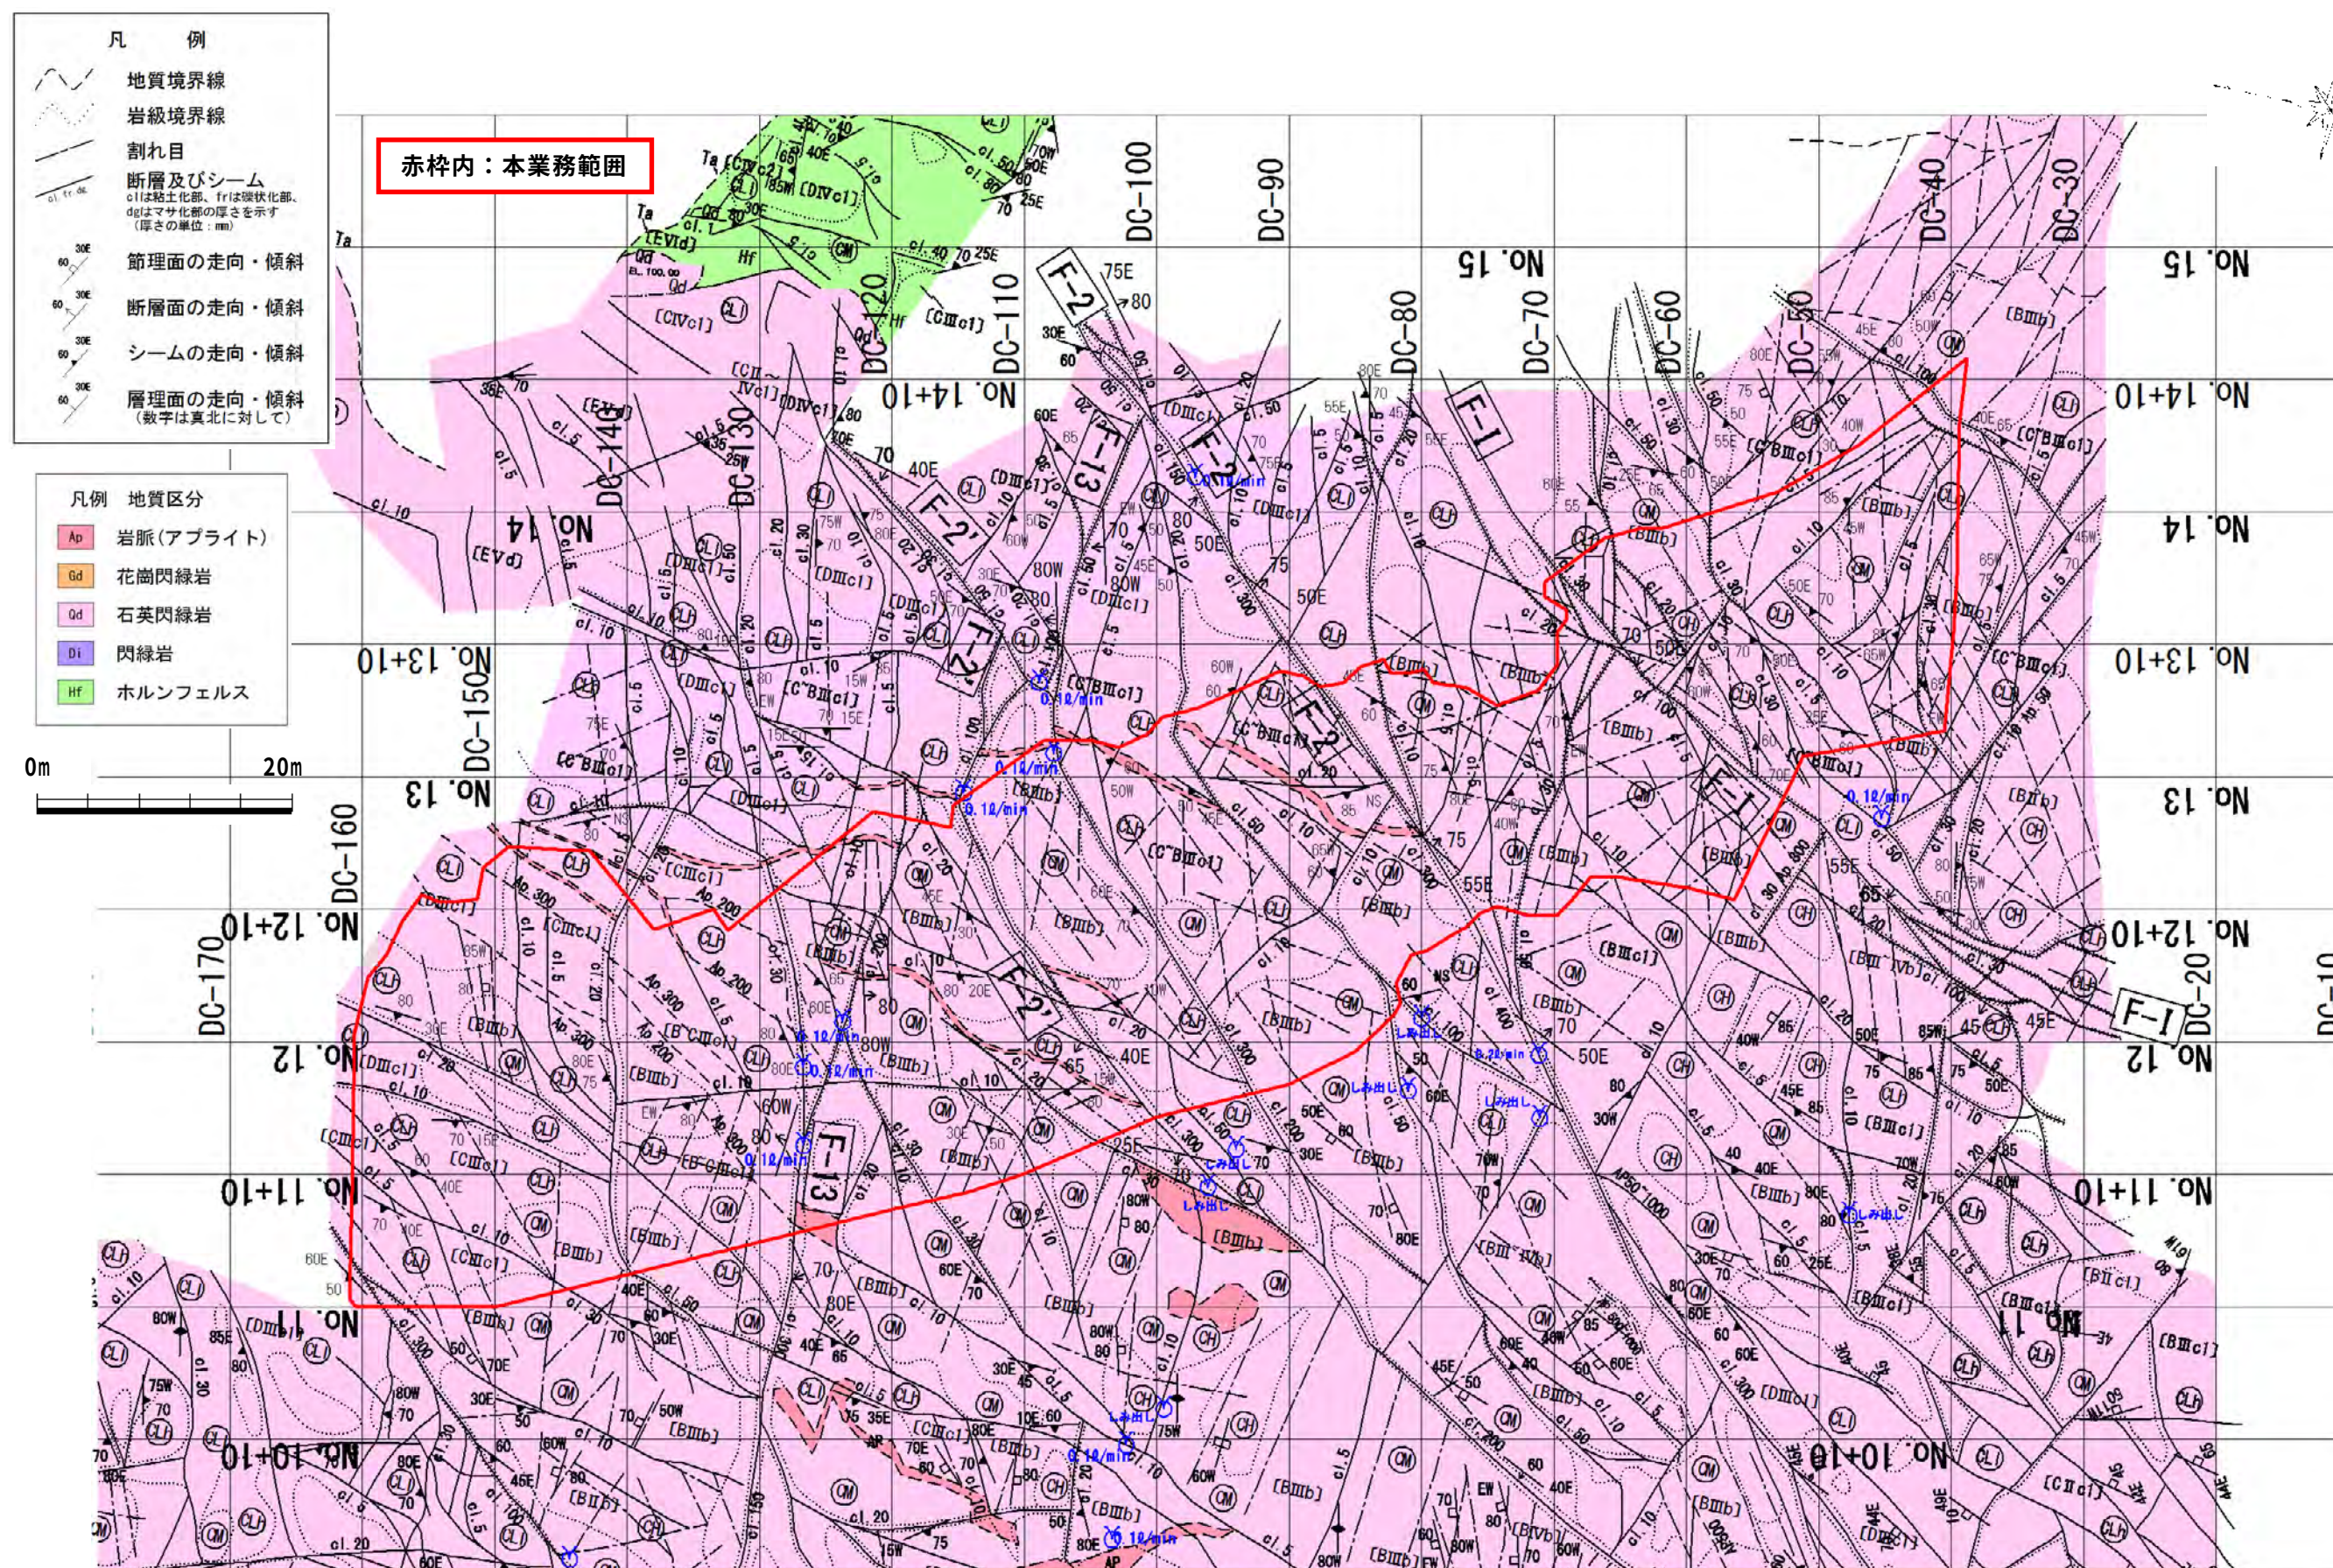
岩盤スケッチ平面図(地質区分)(上流側)
